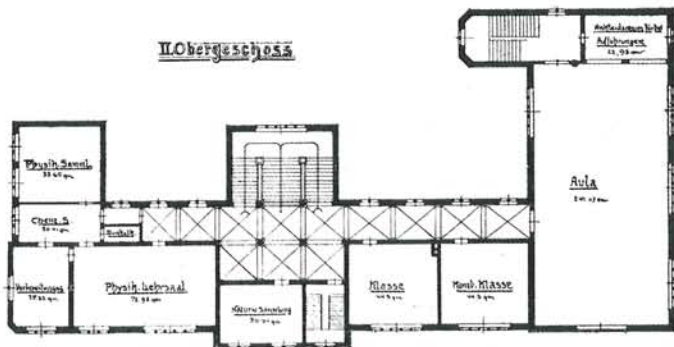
Heutiger Grundriss des 2. Obergeschosses (rechts)
